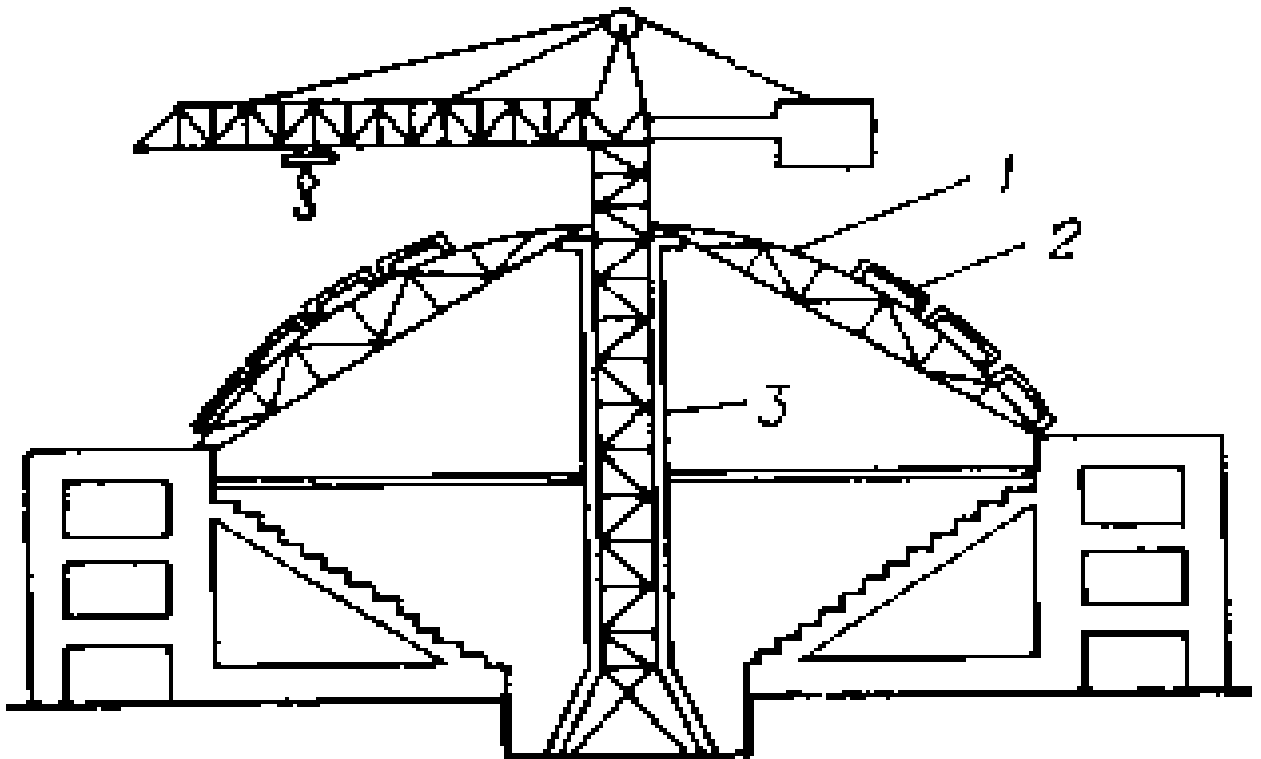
Монтаж купола за допомогою підтримувальних ферм, що опираються на монтажний кран: 1 – інвентарні ферми; 2 – панелі збірного купола; 3 – елементи підсилення башти крана
